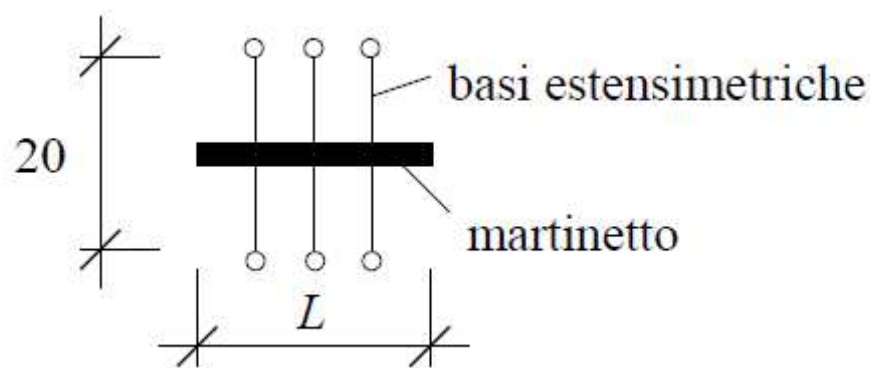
Disposizione del martinetto piatto e delle basi estensimetriche di misura
